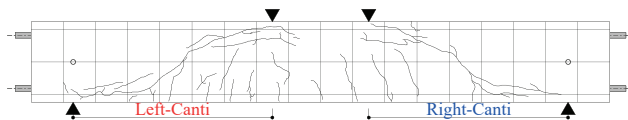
(a) 試験体 GS-00-Shear の最終ひび割れ図
